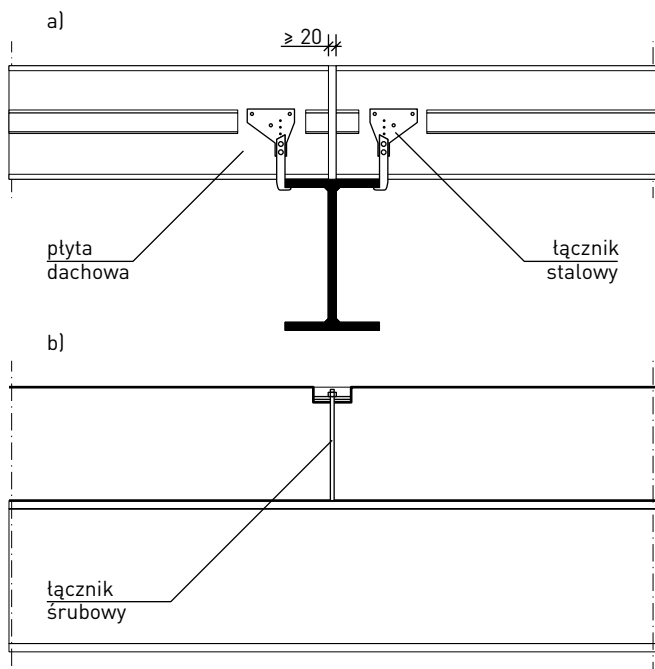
Mocowanie płyt dachowych YTONG do konstrukcji żelbetowej:
